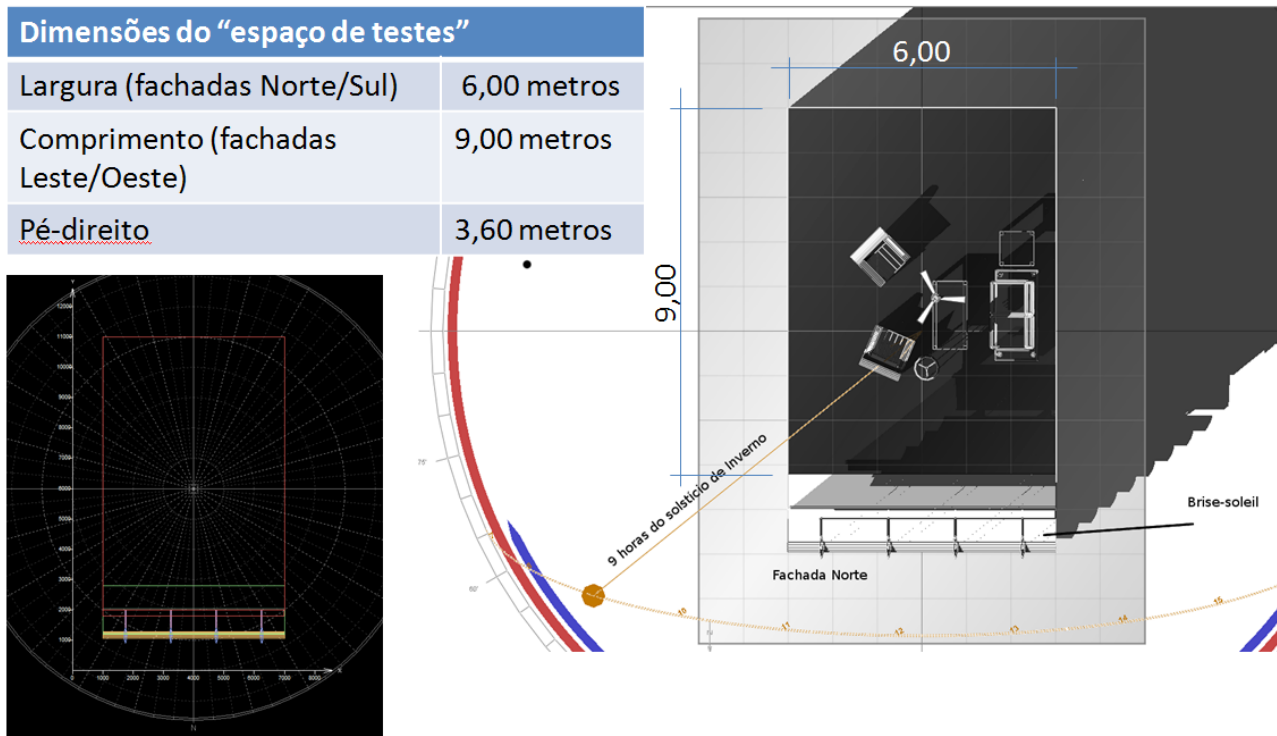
Espaço de testes - Planta com indicação das dimensões gerais e orientação
